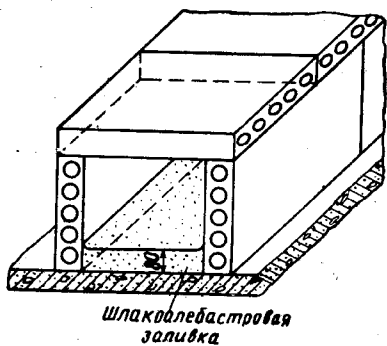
Вентиляционные каналы из перегородочных плит
